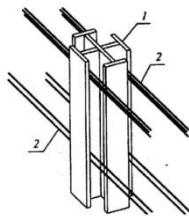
Метод соединения - продольные арматуры пересекают узел: 1 - профиль в колонне; 2 - продольные арматуры пересекают узел
